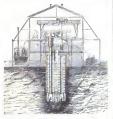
Sezione trasversalo d'una pila durante il lavoro di fondazione col sistema ad aria compressa.
